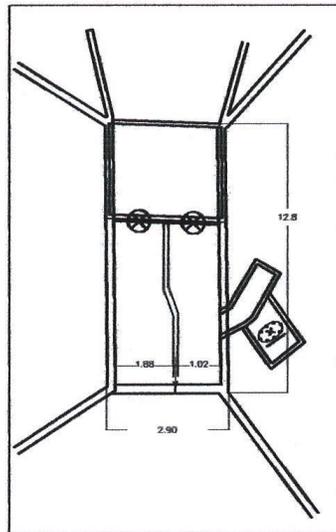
Detalles de la obra de captación a ajustar, vista en planta.
